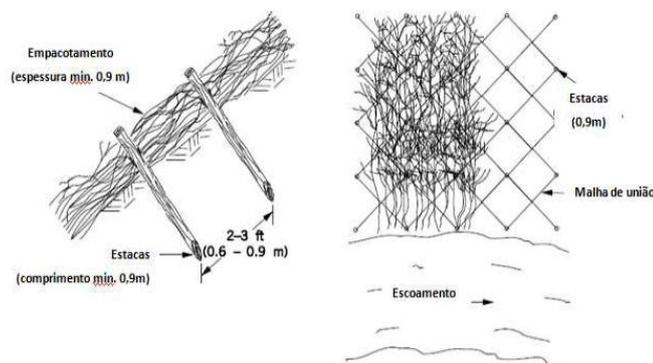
Desenho em que se ilustra um corte transversal e uma simples planta geral, do sistema de empacotamento (M. Lemos 2008).
